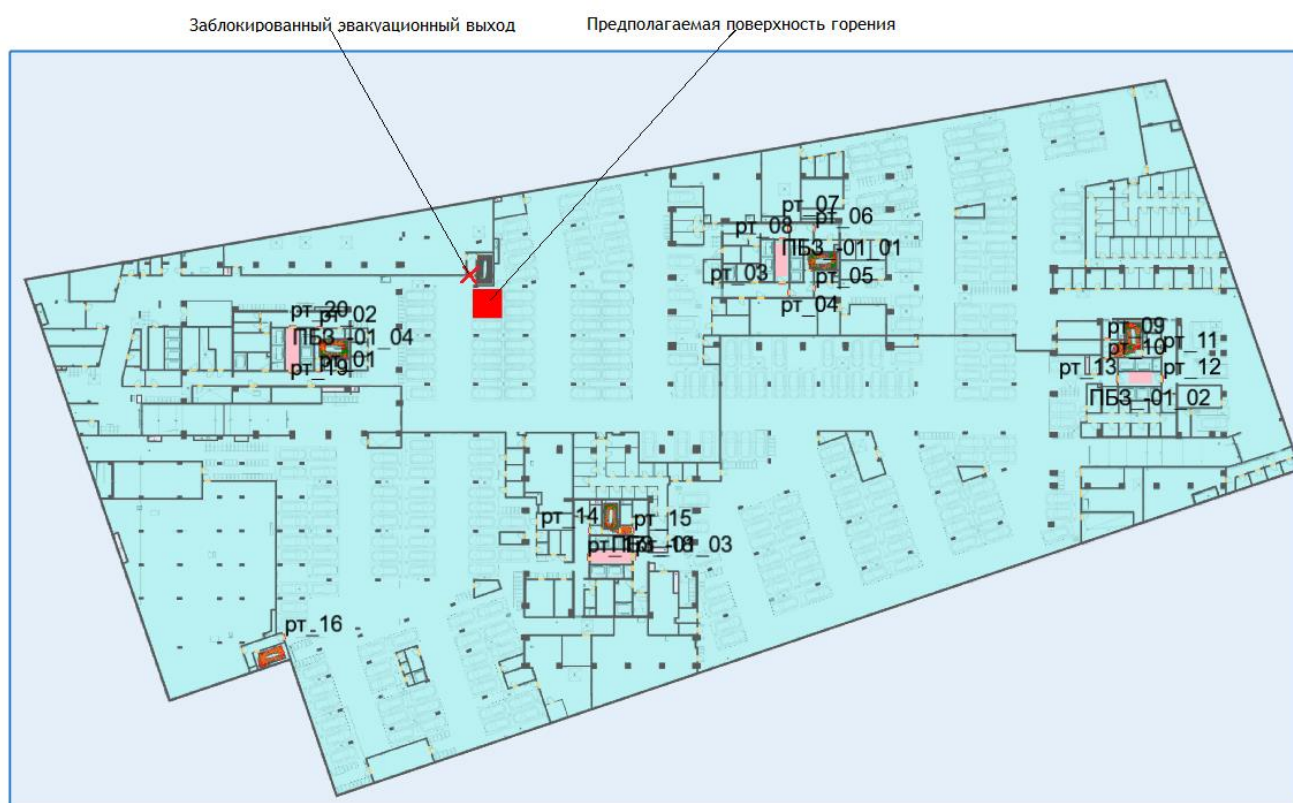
План минус 1-го этажа и нанесенная на него расчетная (принципиальная) схема эвакуации (расположение людей на момент полной эвакуации с этажа пожара – 2 мин. 38 сек.)
